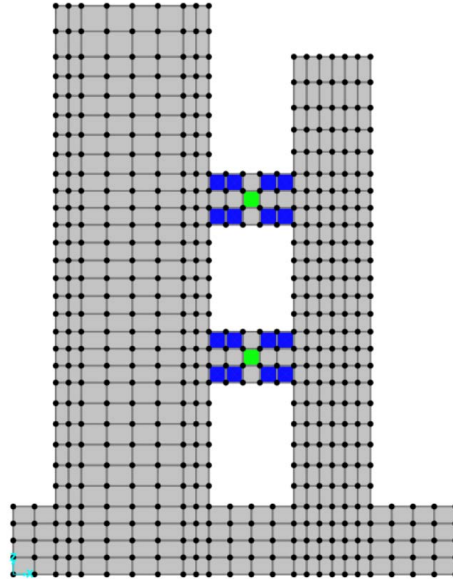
Elementos modificados (verde y azul) para incorporar la armadura diagonal en vigas de acople
